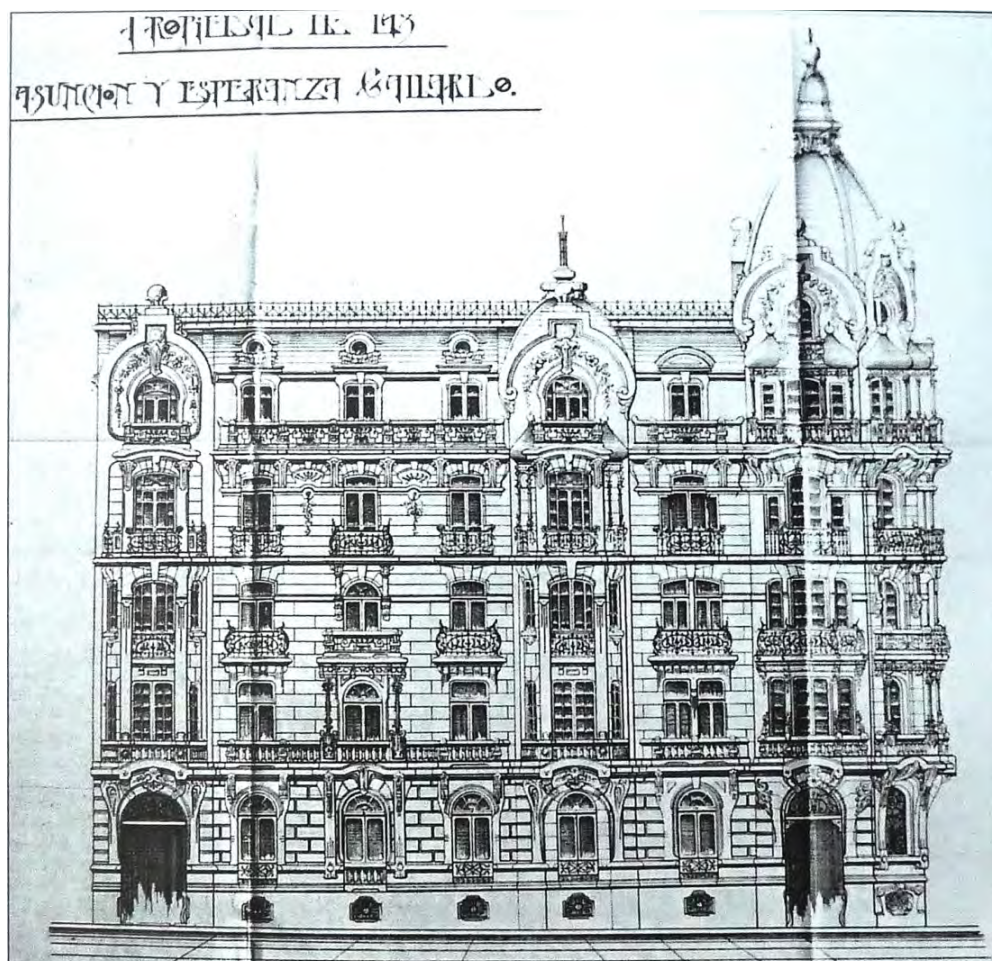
Alzado de la Casa Gallardo hacia la calle de Ferraz, 1911. Arquitecto: Enrique F. Daverio.
